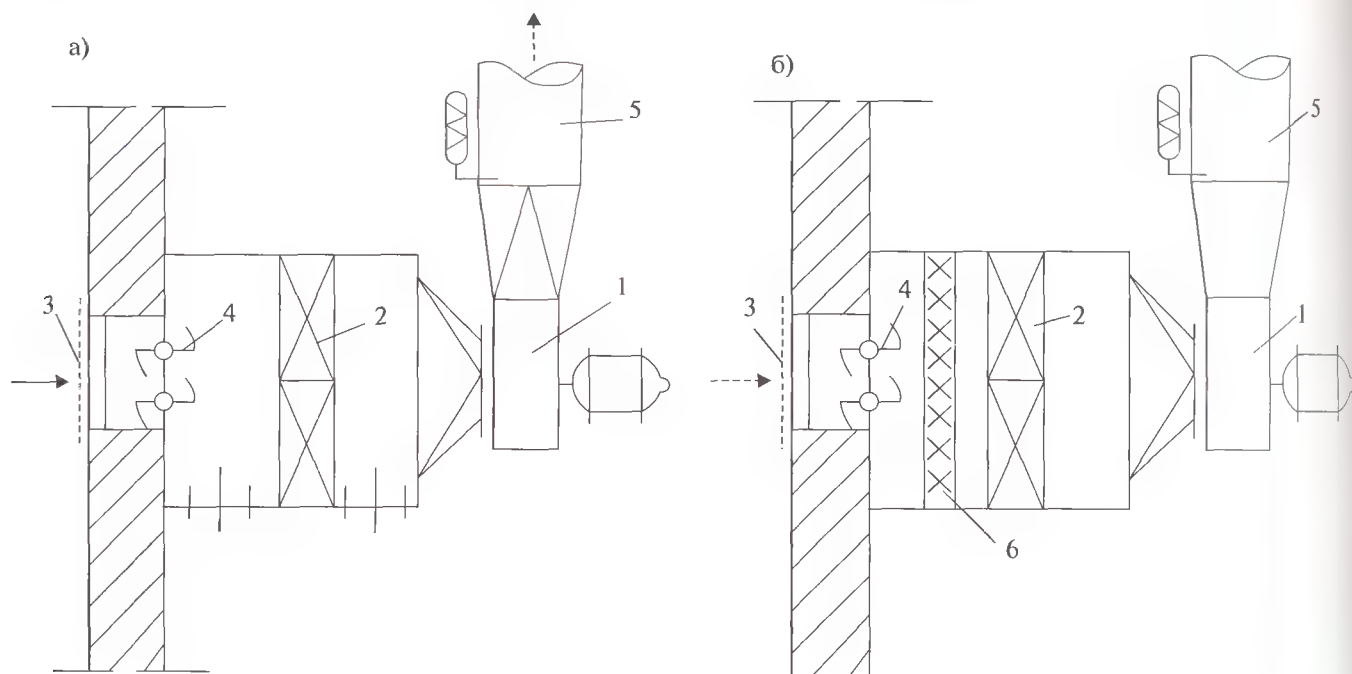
Схемы приточных камер систем общеобменной вентиляции
